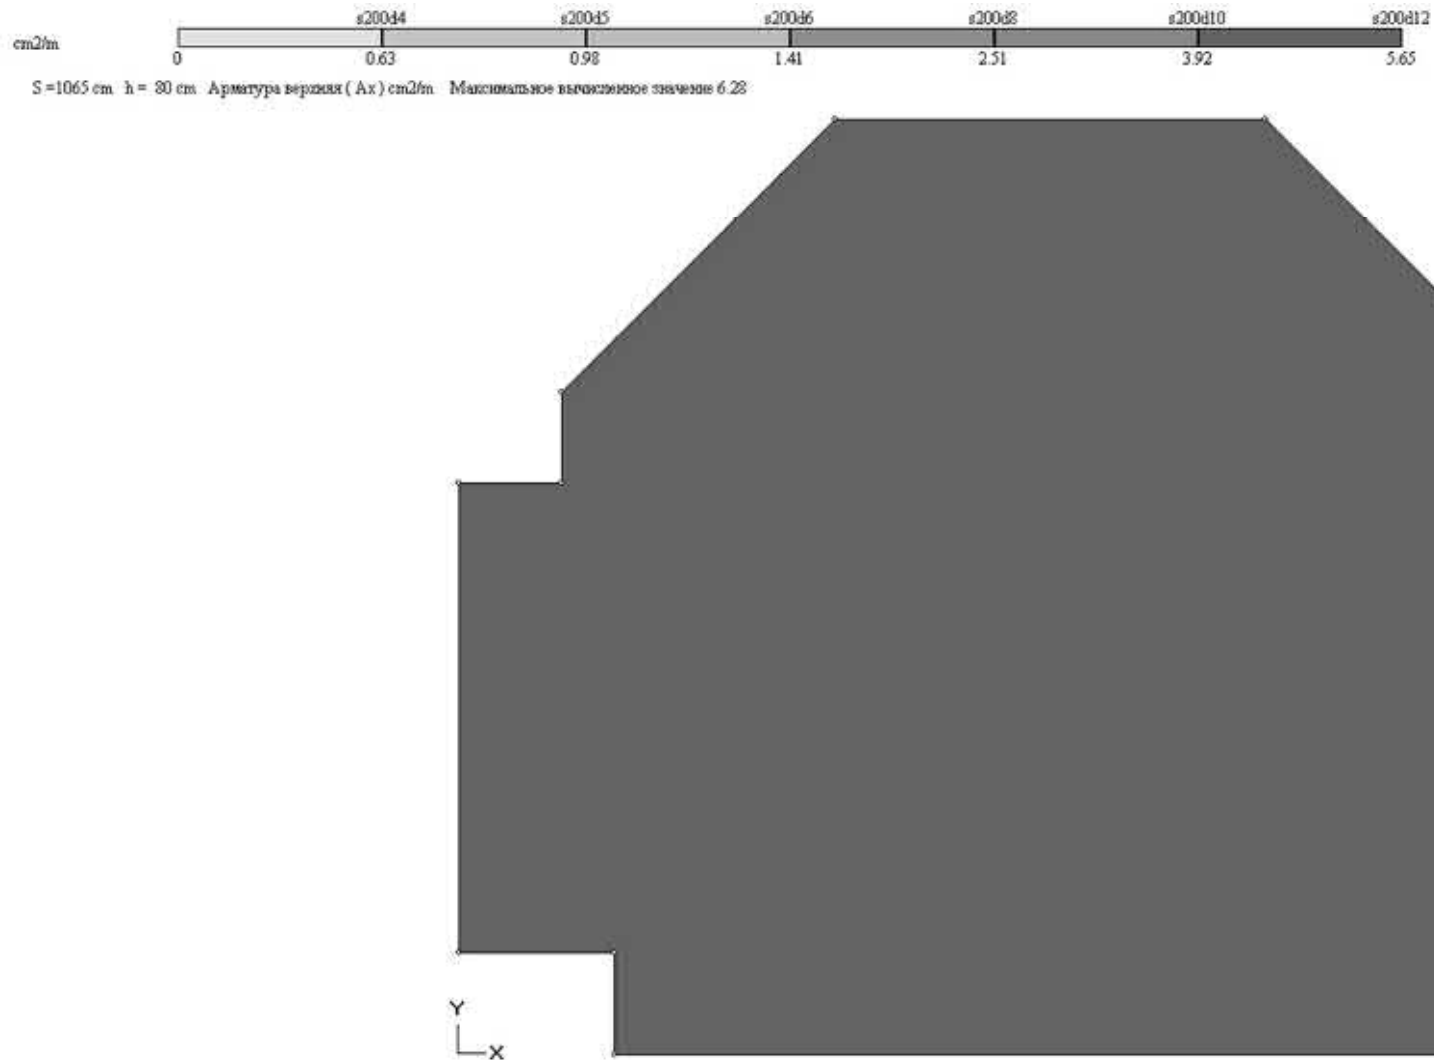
Изополя необходимой площади стержней верхней арматуры фундаментной плиты вдоль оси X
